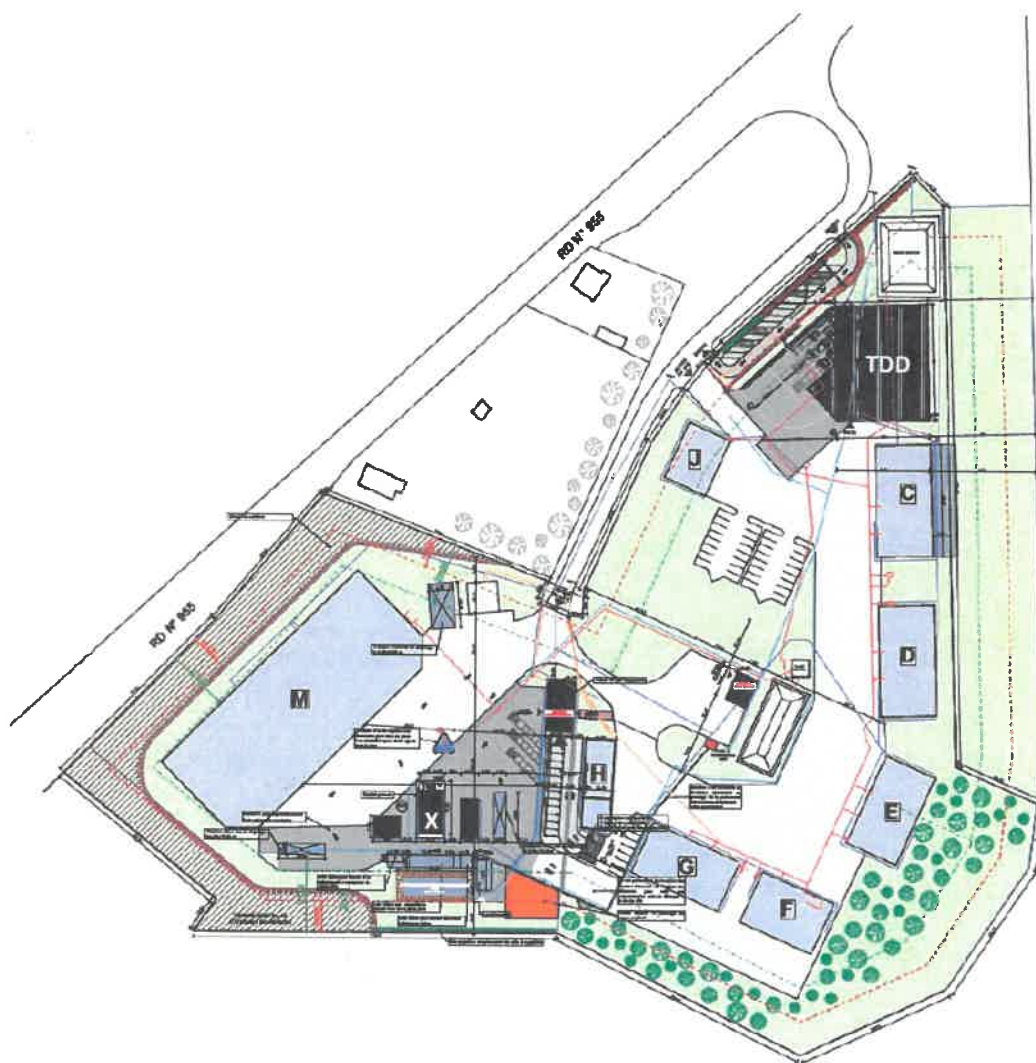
Plan de masse de la configuration future du site de CMS High Tech (échelle 1/3547)
